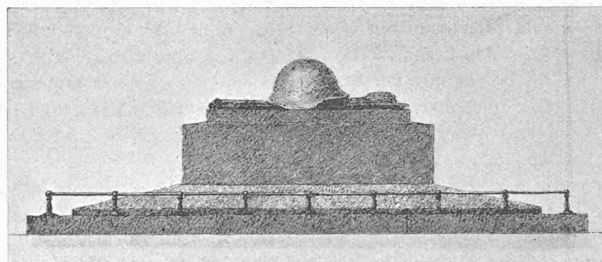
und 6. Grundriss und Aufriss. — Masstab 1:50.
